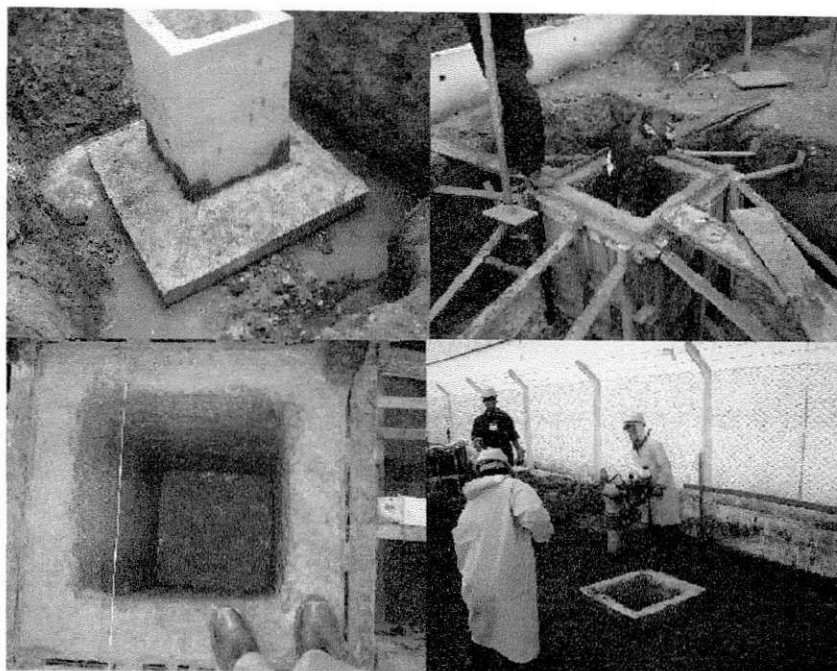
Concretagem, Compactação e Limpeza do Cálice.
